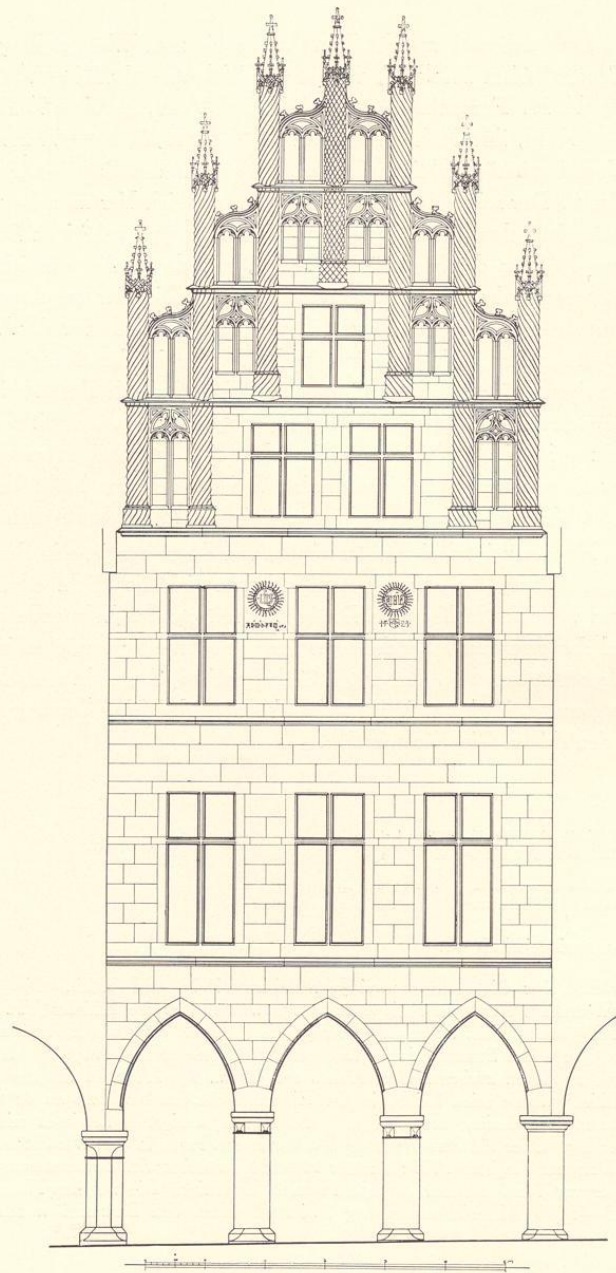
Rekonstruktion des Hauses Prinzipalmarkt 41
